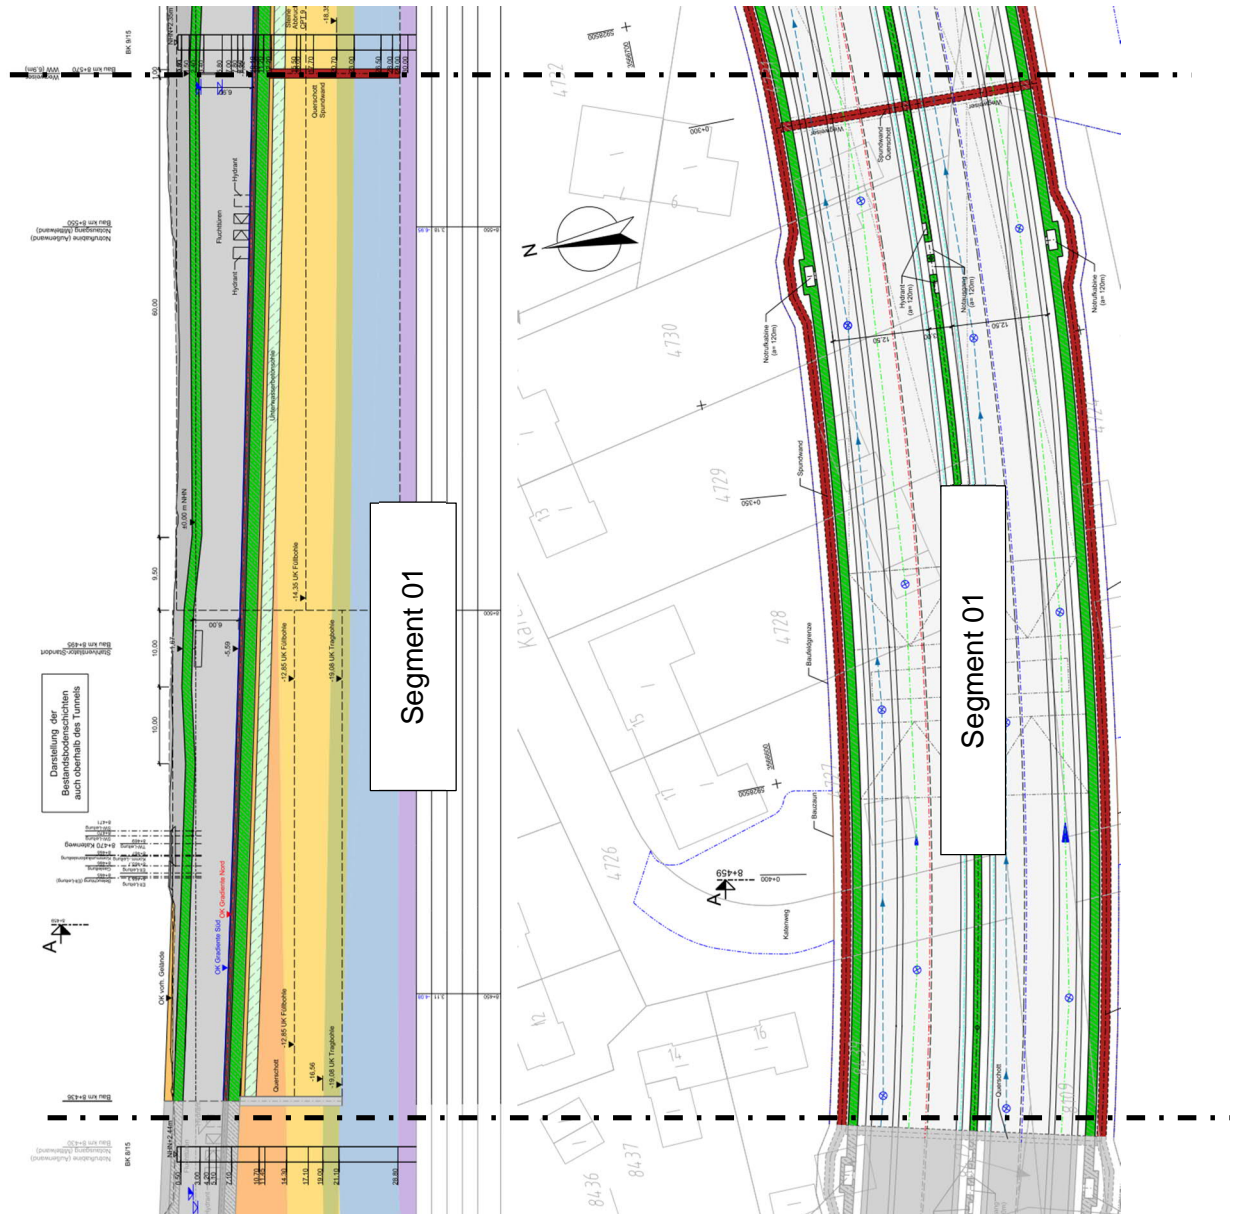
Beispiel Lageplan und Längsschnitt Trog-/ Tunnelbauwerk, Segment 01,
